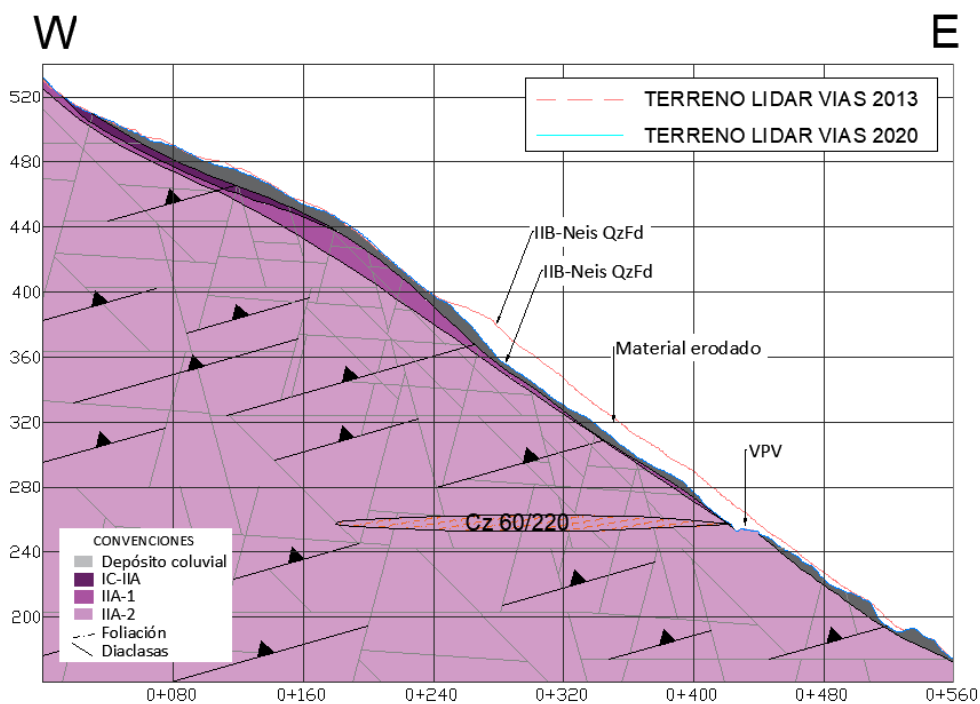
Perfil geológico (Sección 2) – La Honda.
